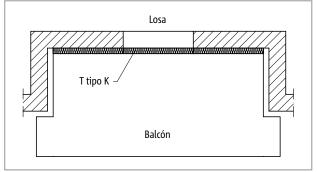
Schöck Isokorb® T tipo K: Balcón en fachada saliente
